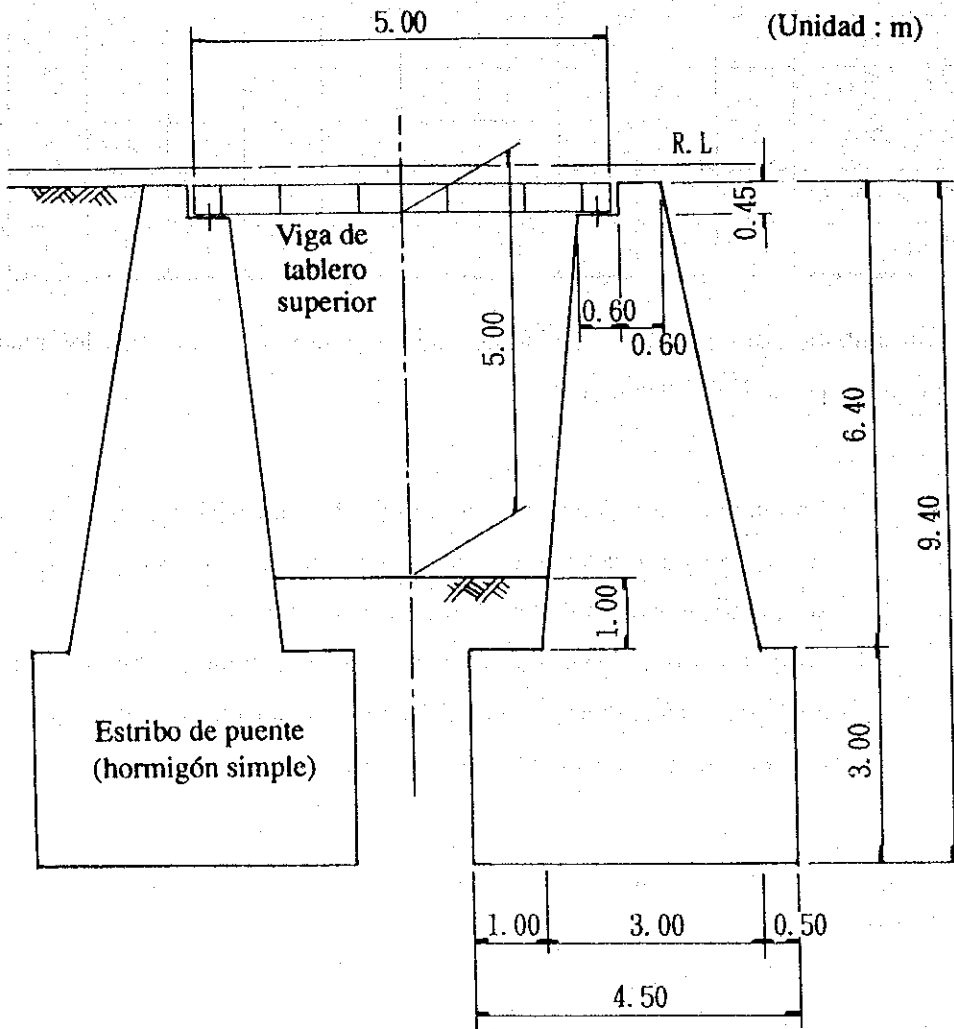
Plano Normal de Puentes (1) (Longitud: 5,00 m)
